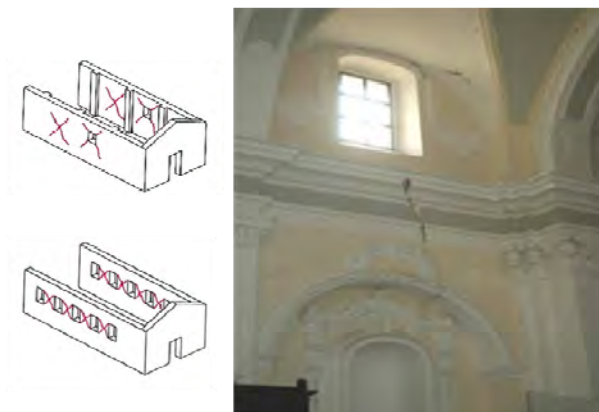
Mecanismo 6 - Fissuração por acção de corte nas paredes laterais [C.N.R., 2002]
